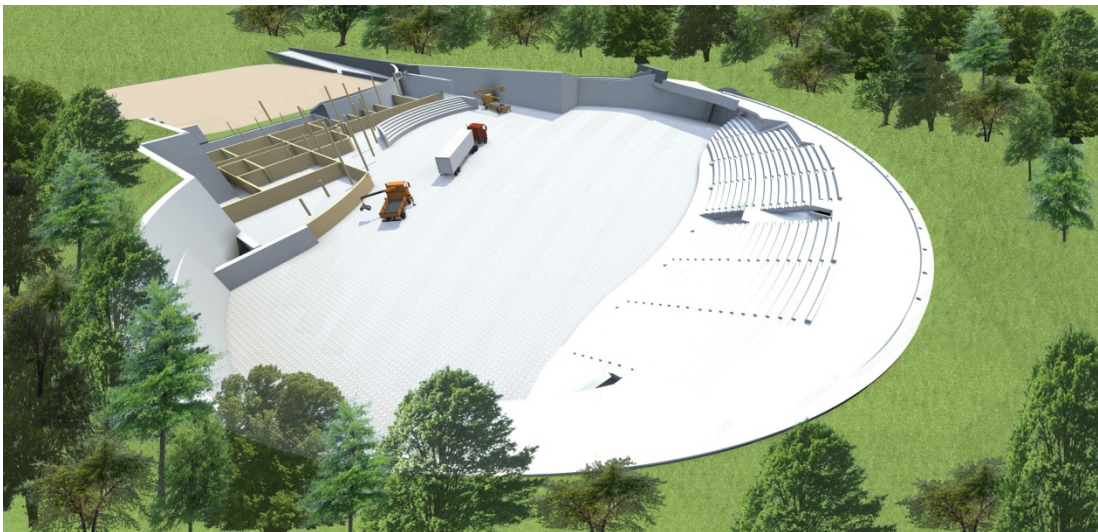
FASE DI CANTIERE - GETTO TRIBUNE
